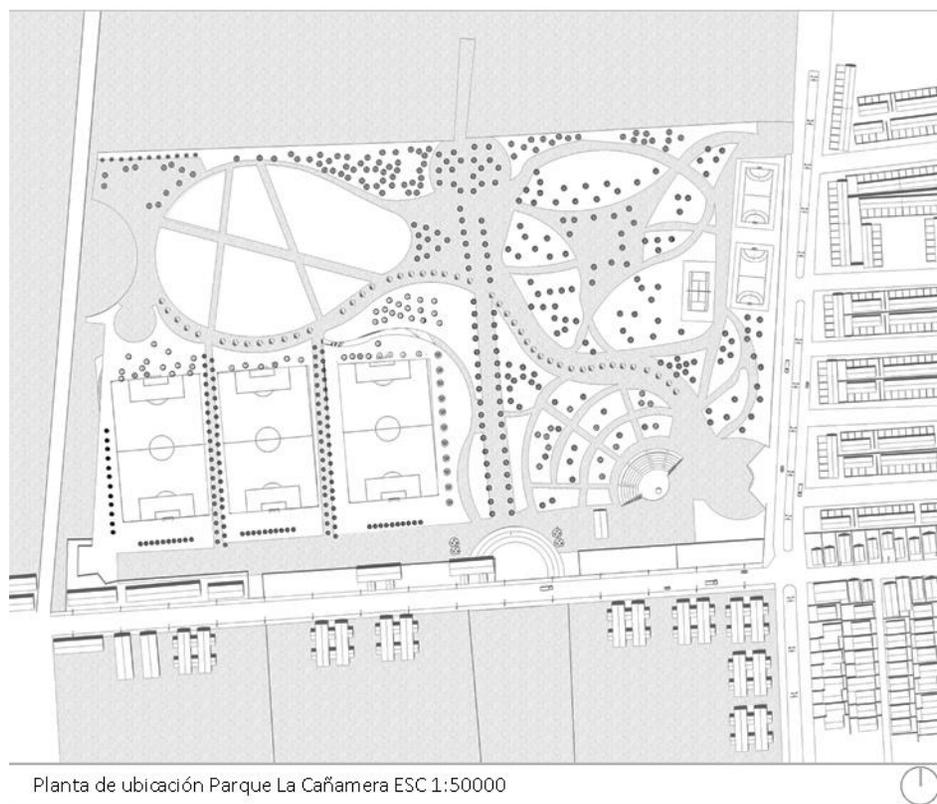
Planta de Ubicación Parque La Cañamera, Puente Alto, R. Metropolitana.
